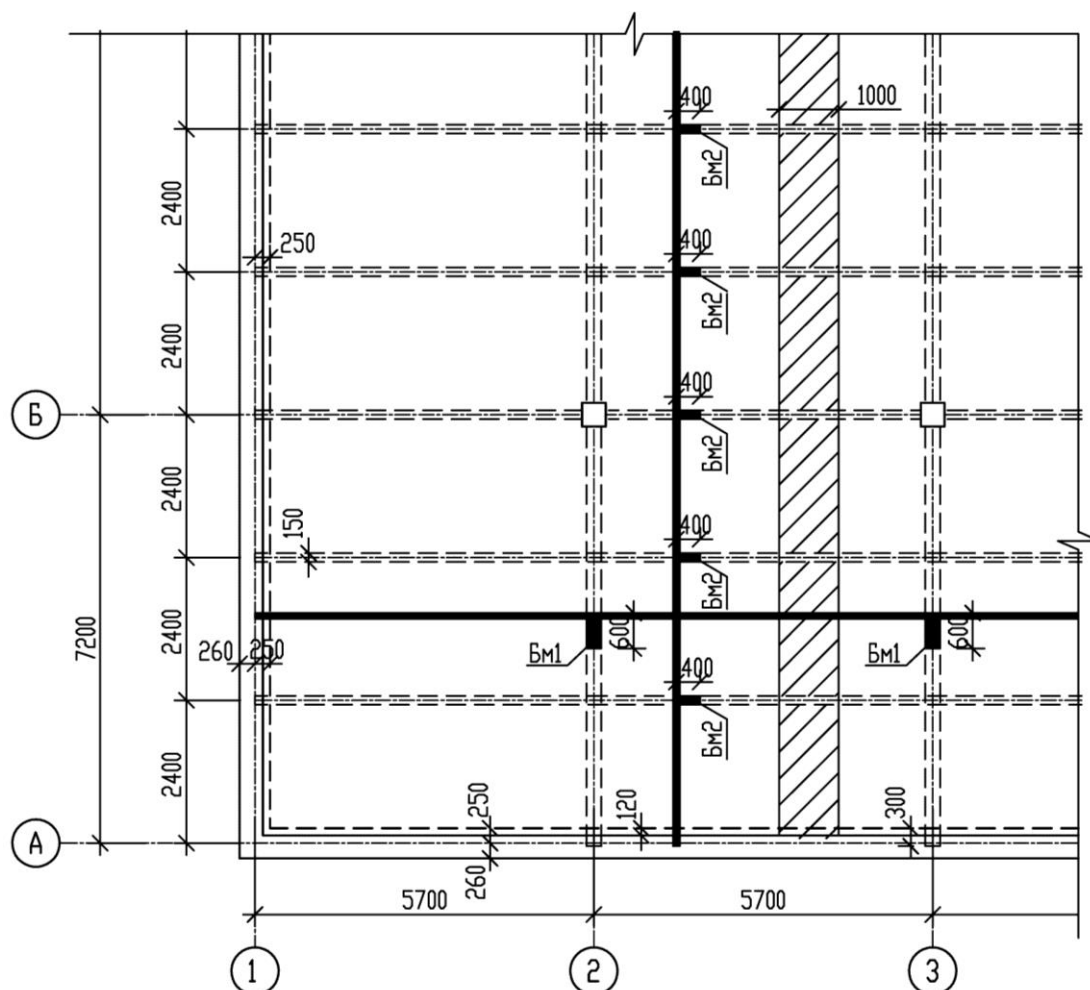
Конструктивная схема монолитного перекрытия:
